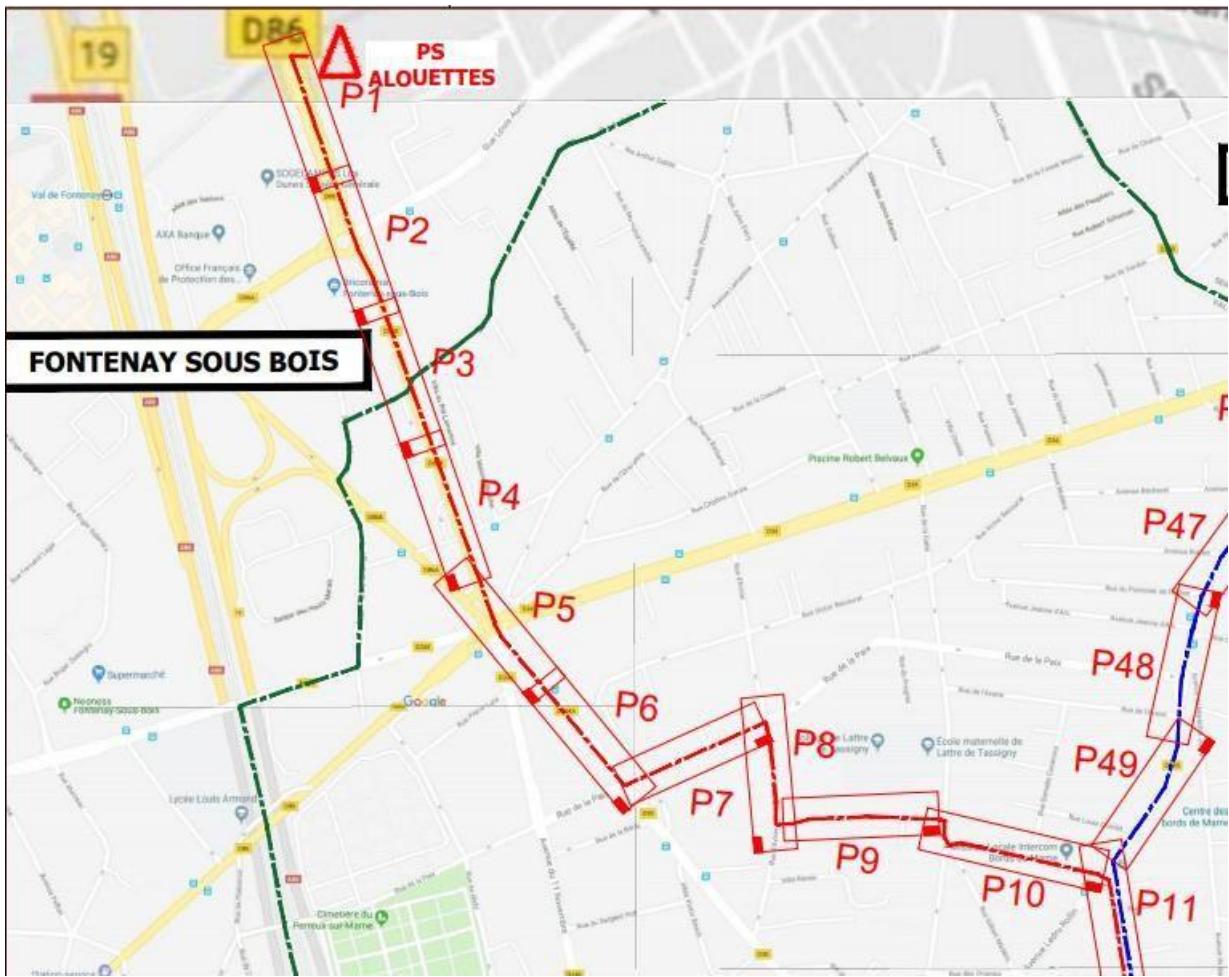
Partie d'un plan de découpage des planches sur un gros projet
